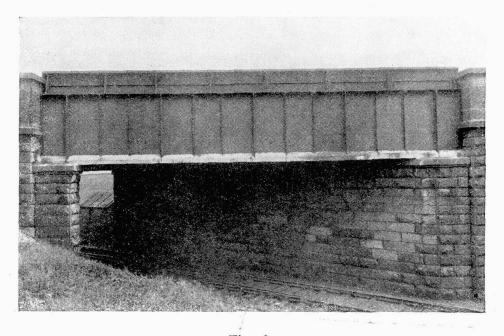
Träger mit repariertem Stegblech. — Poutres dont l'âme est réparée. Girder showing repaired web.
